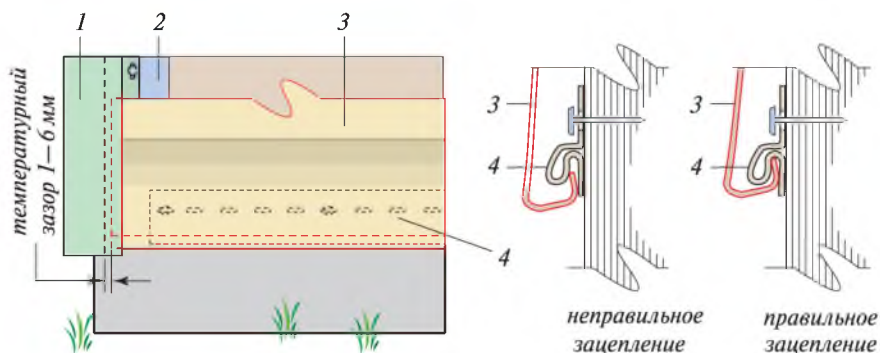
Установка первой рядовой панели сайдинга: 1 — угловой профиль; 2 — подложка (гидроизоляция) из кровельной жести; 3 — рядовая сайдинговая панель; 4 — стартовый профиль
